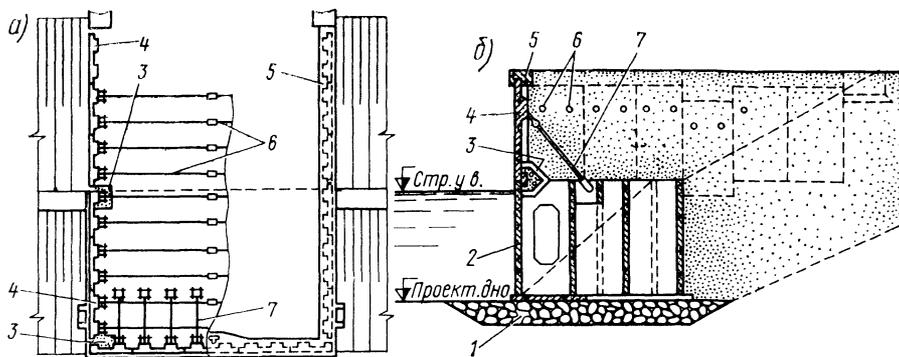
Конструкция бычка при укрепленном береговом откосе:
